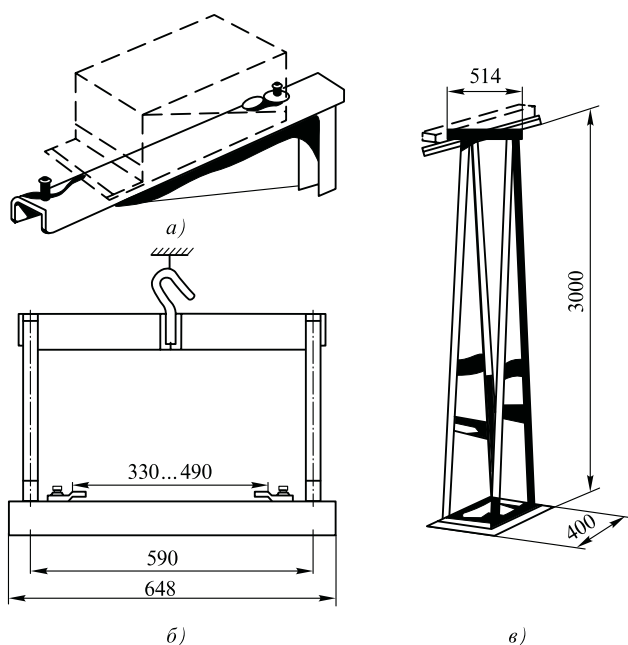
Опорные конструкции для магистральных шинопроводов:
